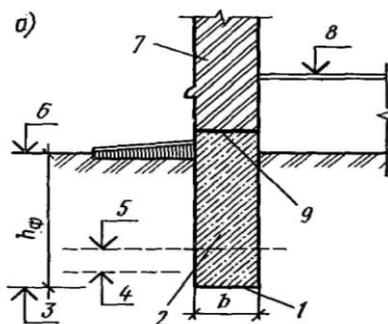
Определение глубины заложения фундаментов: а – схема: 1 – подошва фундамента; 2 – тело фундамента; 3 – отметка глубины заложения фундамента; 4 – отметка глубины промерзания грунта; 5 – отметка уровня грунтовых вод; 6 – планировочная отметка; 7 – стена; 8 – уровень пола 1 этажа; 9 – обрез фундамента; $h_{\text{ф}}$ – глубина заложения фундамента; b – ширина подошвы фундамента.
